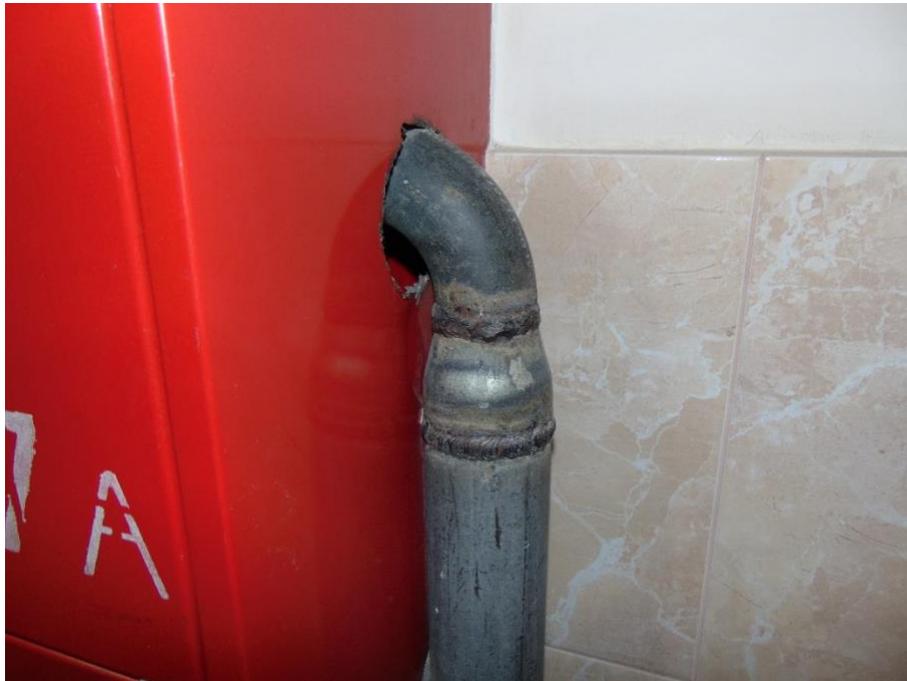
Коррозия противопожарного трубопровода и сварных соединений
